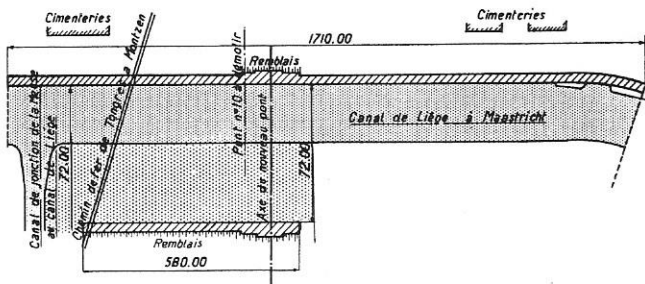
Plan des murs, rive gauche et rive droite, du canal élargi.
